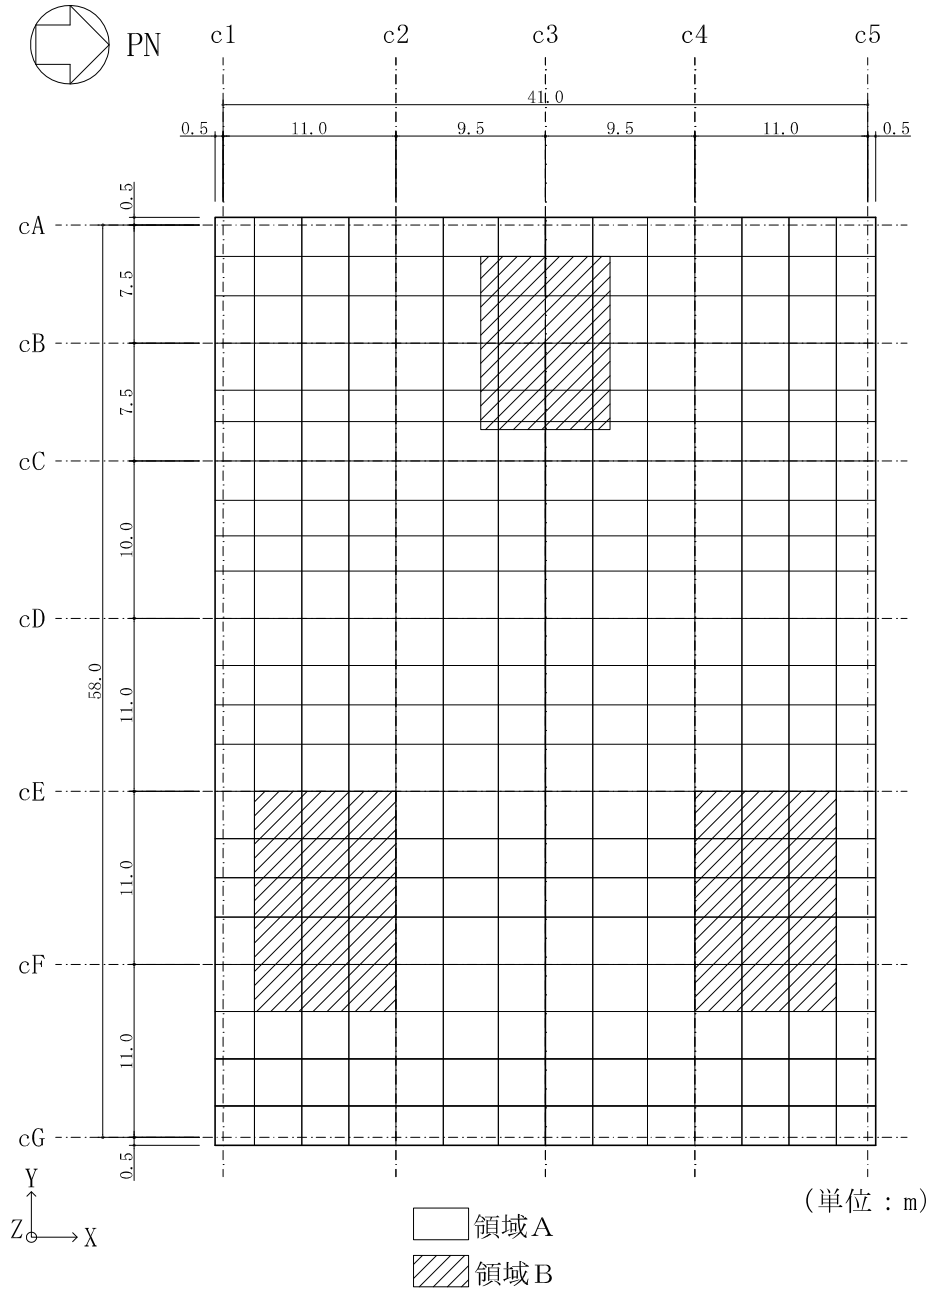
基礎スラブの配筋領域図 (EW 方向, 上ば筋)
